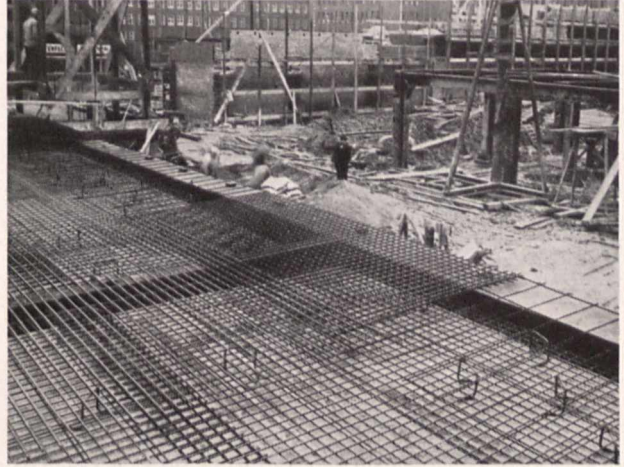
Luftschutzräume erfordern besonders starke Deckenkonstruktionen. — Bewehrung einer Luftschutzdecke mit Baustahlgewebe leistet dafür gute Dienste
